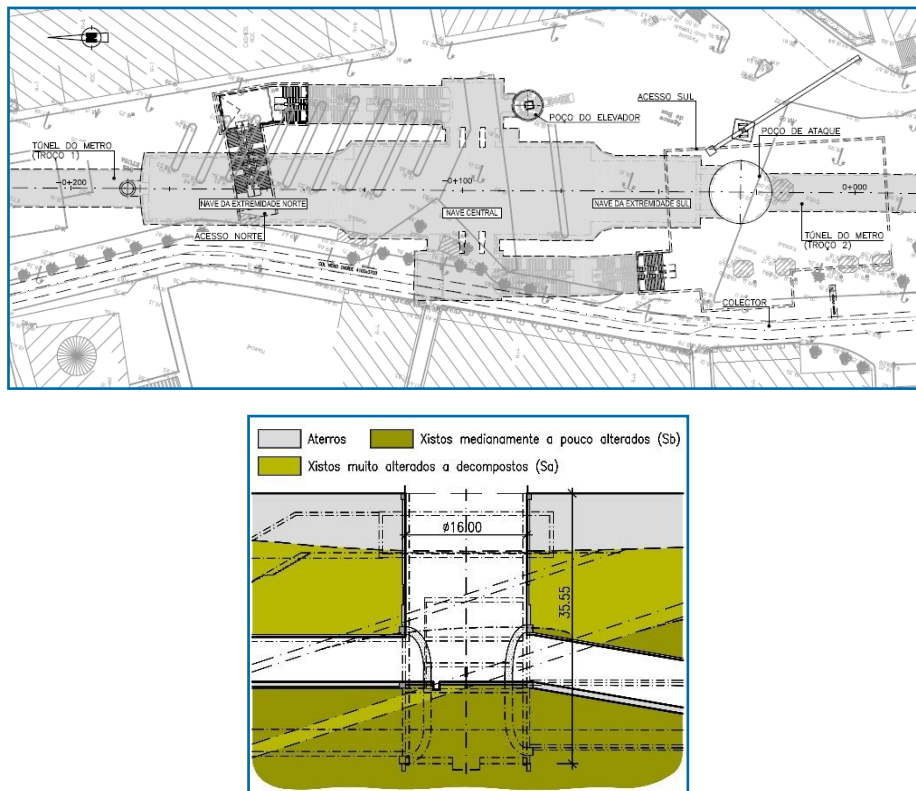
Planta de localização da Estação *Place des Martyrs* e corte transversal pelo poço de ataque
